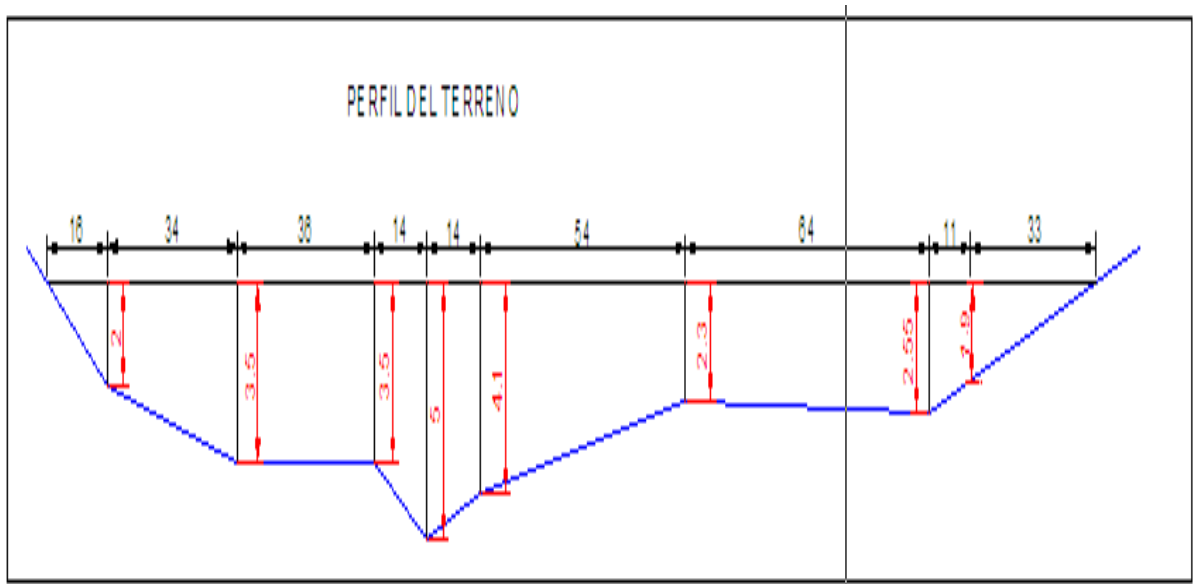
Levantamiento y Perfil del De la Boquilla de la Presa.
